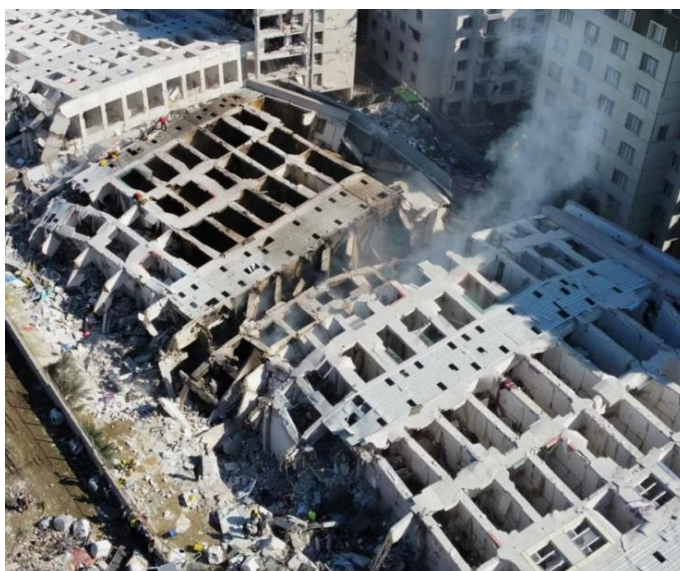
Примеры разрушения железобетонных зданий во время землетрясения в Турции, 2023 г.
